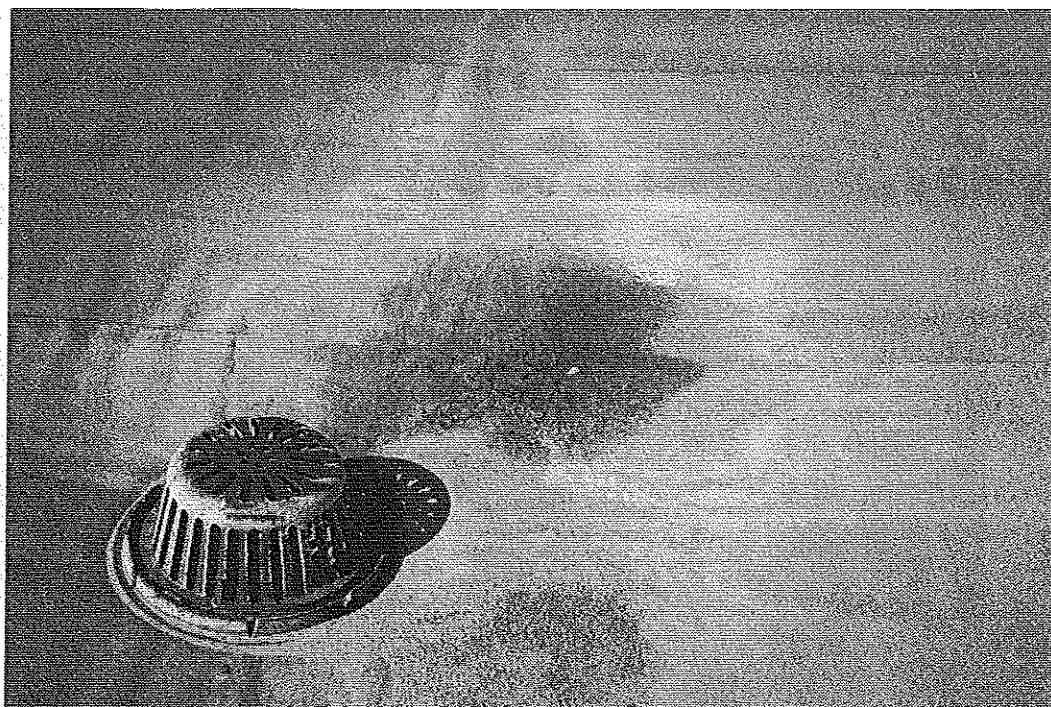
Utilisation d'une entrée d'eaux pluviales en fonte (toiture au Canada). © J. Putatti
